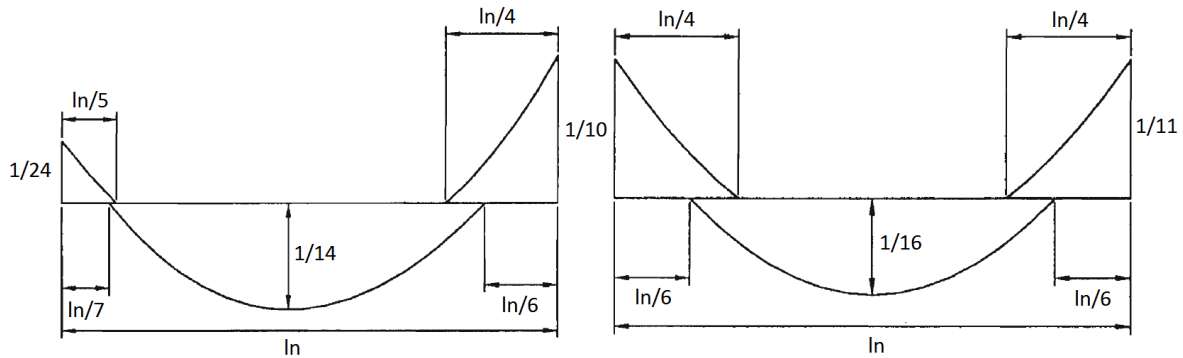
Corte del refuerzo en tramos exteriores e interiores de las viguetas.
